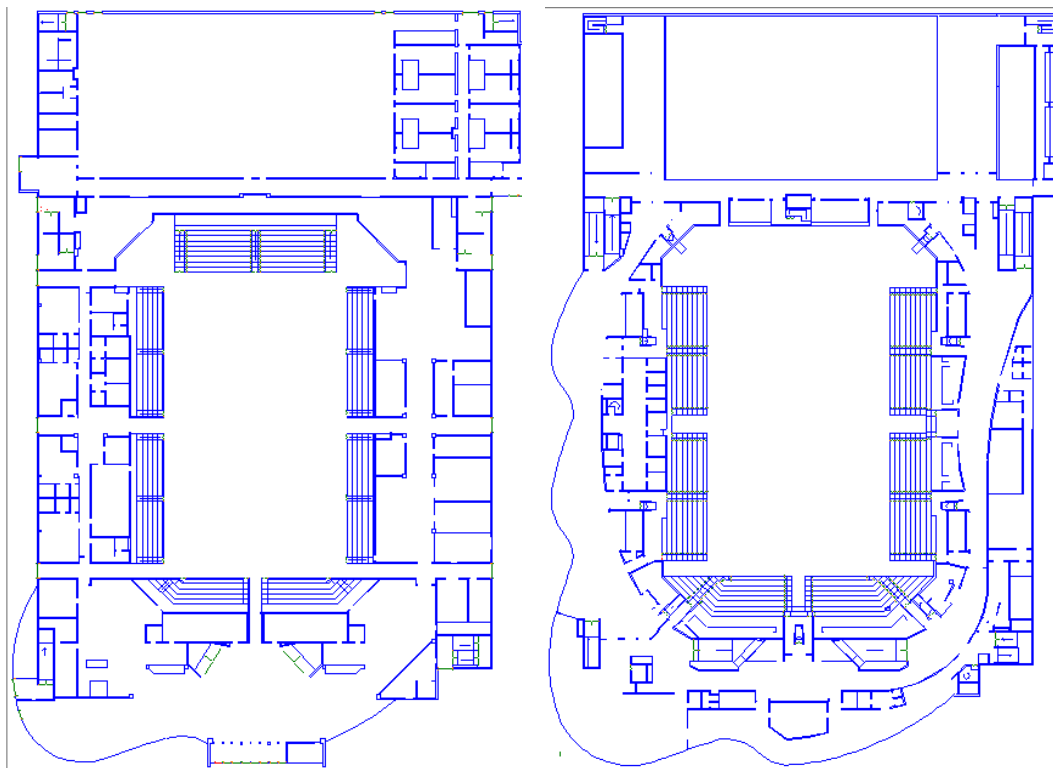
Simuleringens utseende efter 420 sekunder. Till vänster syns plan 1 och till höger plan 2.
